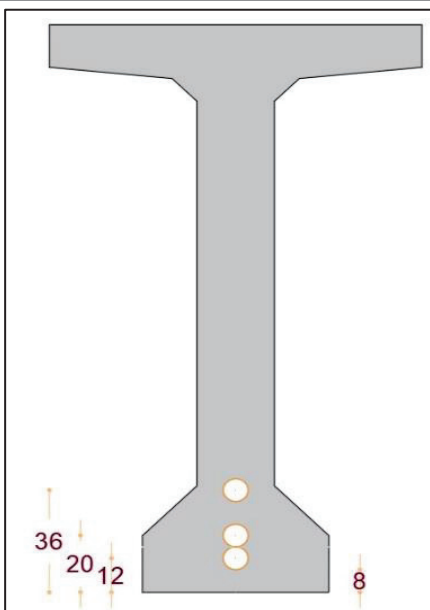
POSITION DES CABLES-SECTION MEDIANE.
